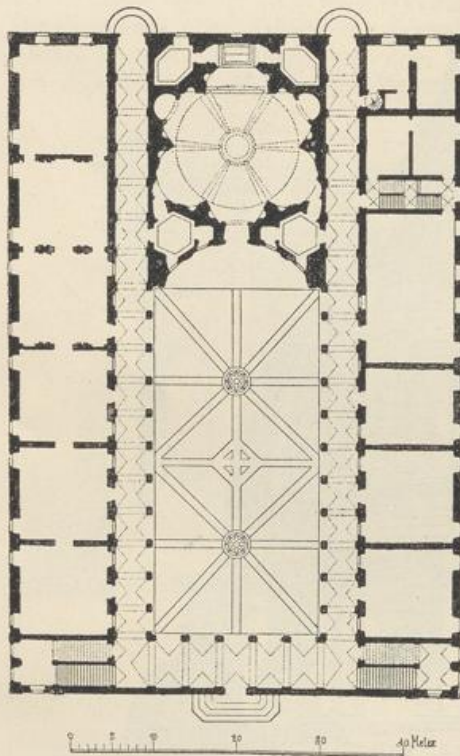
Grundriss der Sapienza zu Rom
